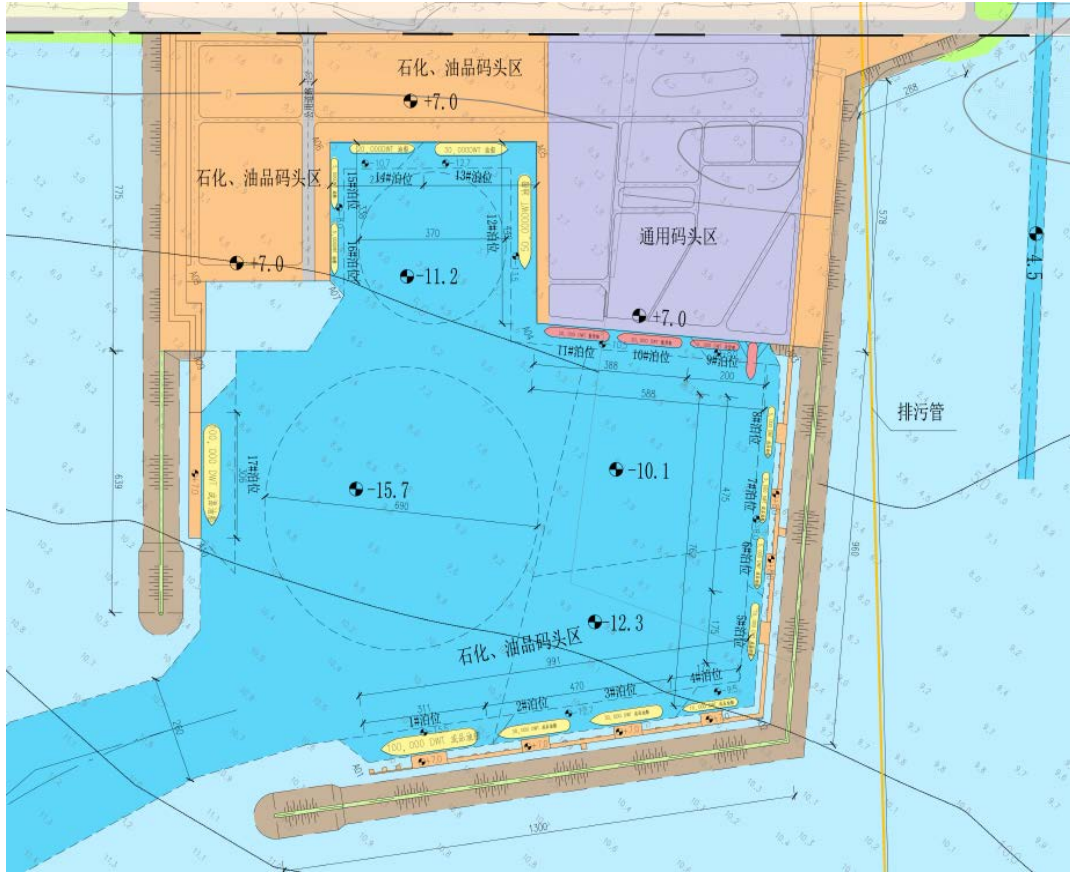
南海作业区规划方案南海作业区 1#港池规划图
